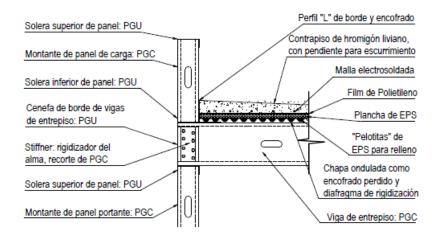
Sección de cubierta plana Steel Frame. Fuente: (ConsulSteel, 2014).
